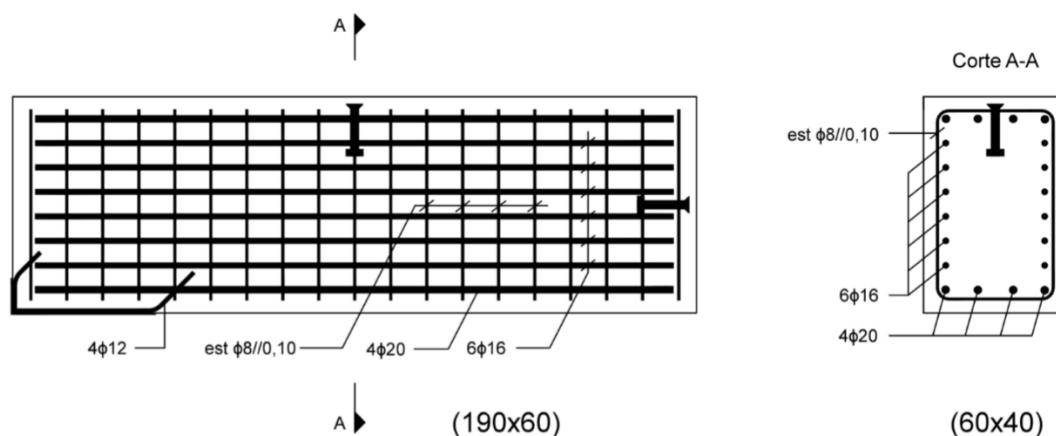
Pormenorização de armaduras do bloco de betão [37]
